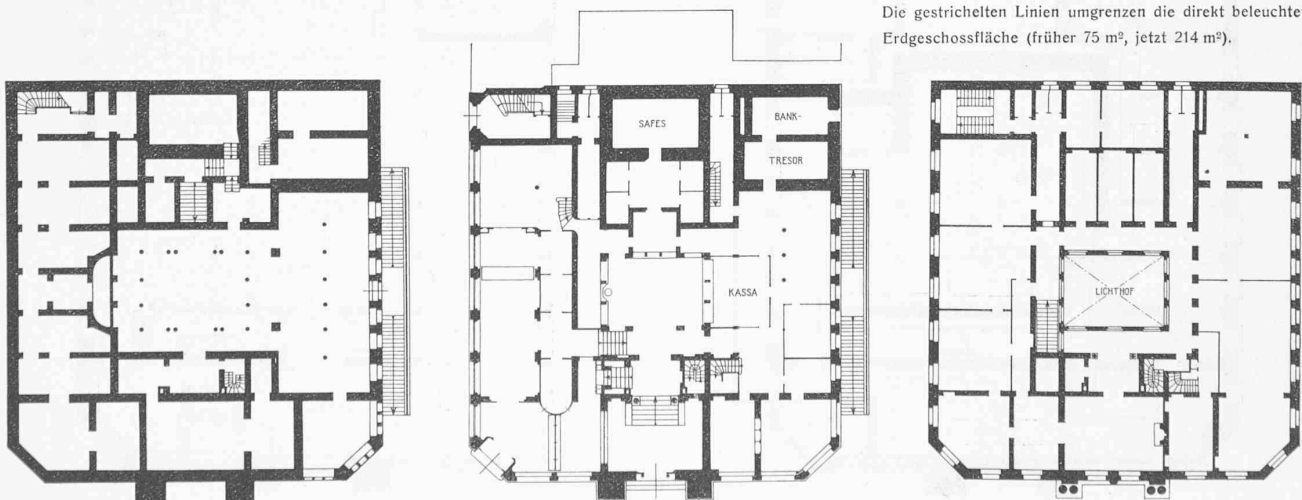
bis 3. Grundrisse von Keller, Erdgeschoss und I. Stock im Zustand vor dem Umbau. — Masstab 1 : 500.
